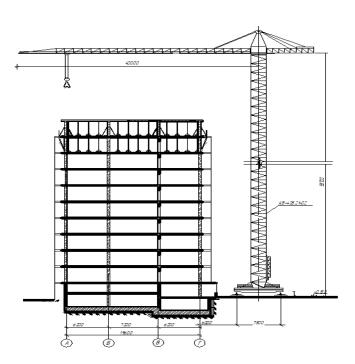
Схема установки башенного крана КБ-408.21-02
